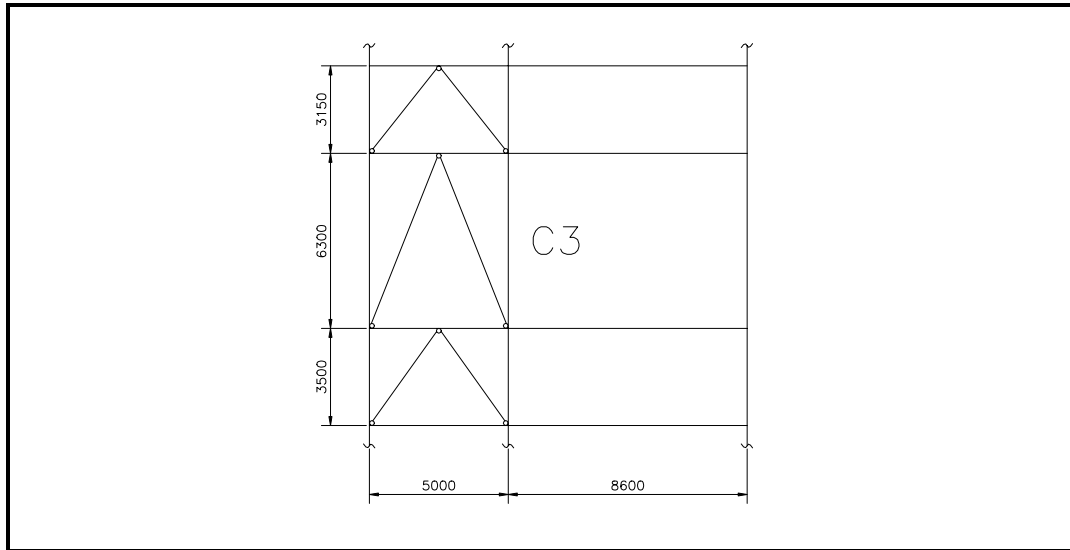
Pórtico contraventado de múltiplos andares.
